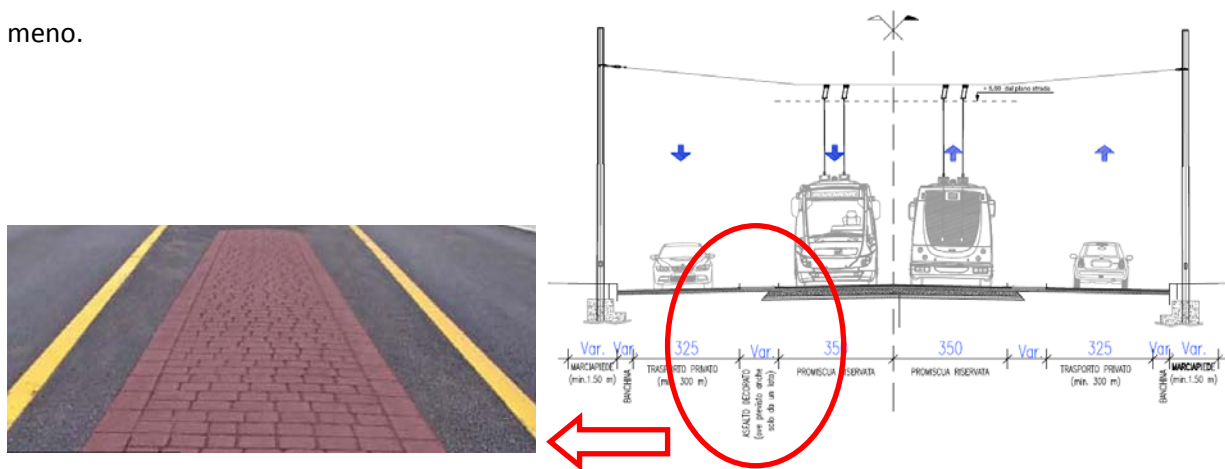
una sezione tipo con separazione con pavimentazione in asfalto decorato ed esempio di applicazione
